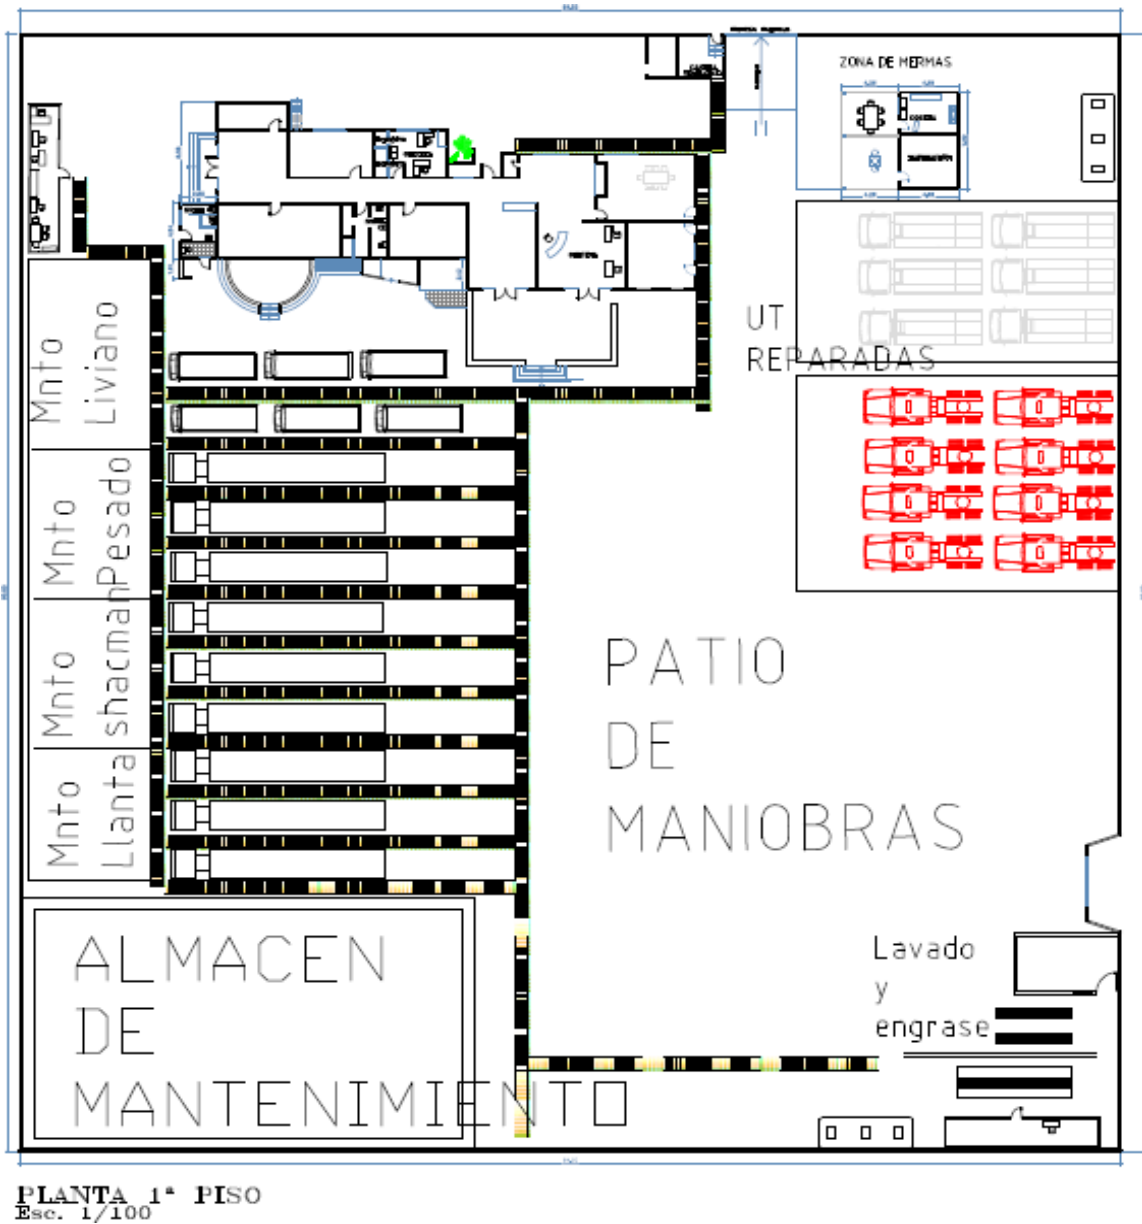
DISTRIBUCIÓN DE PLANTA ANTES
